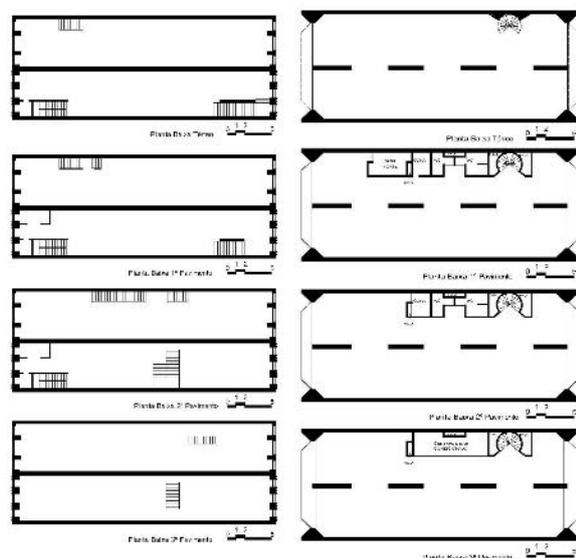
Planta dos sobrados antes e depois da reforma proposta por Jerônimo e Pontual arquitetos para implantação do BANORTE. Oliveira, 2017.
